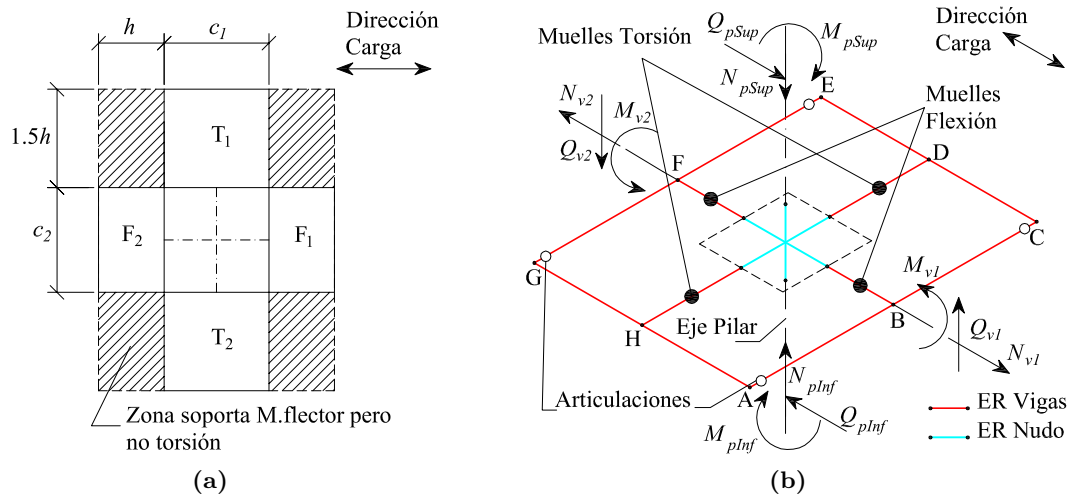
Modelo de Hawkins y Corley para una conexión interior pilar-placa: (a) Vista en planta modelo 3D ; b) Modelo macroscópico de barras
